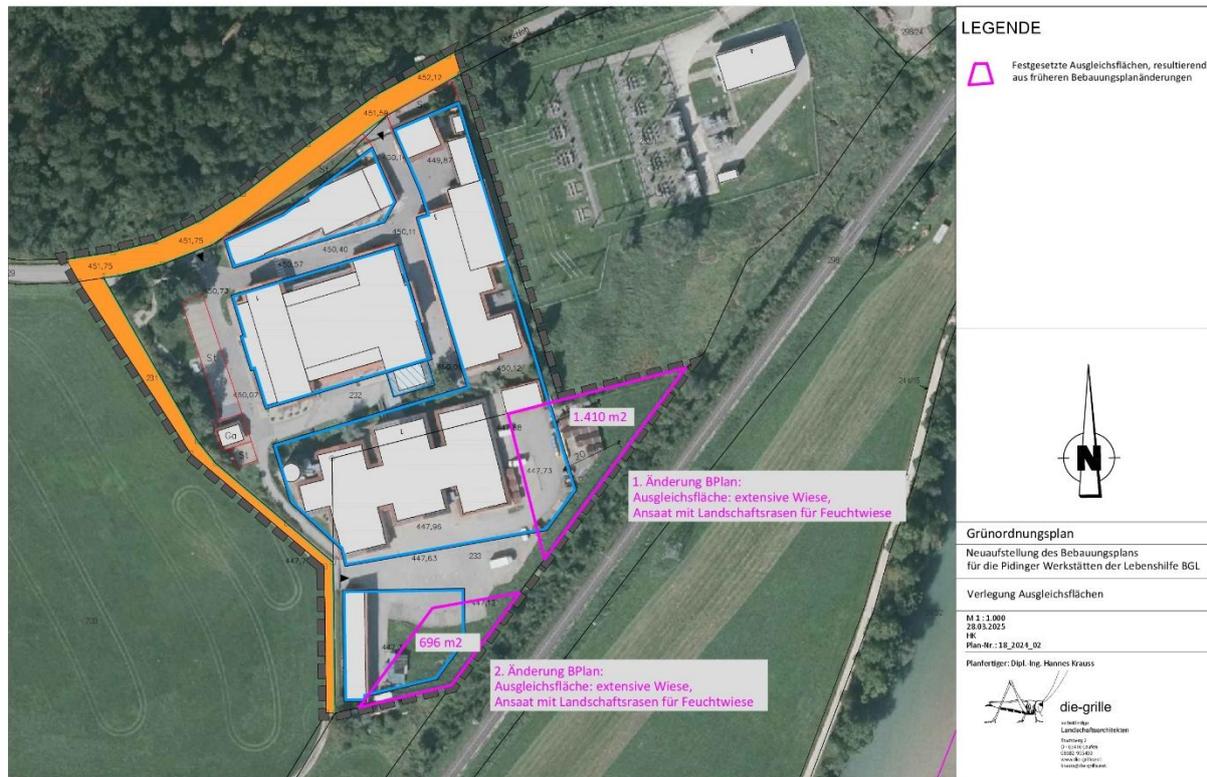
Überlagerung der Ausgleichsflächen mit dem Bestand
